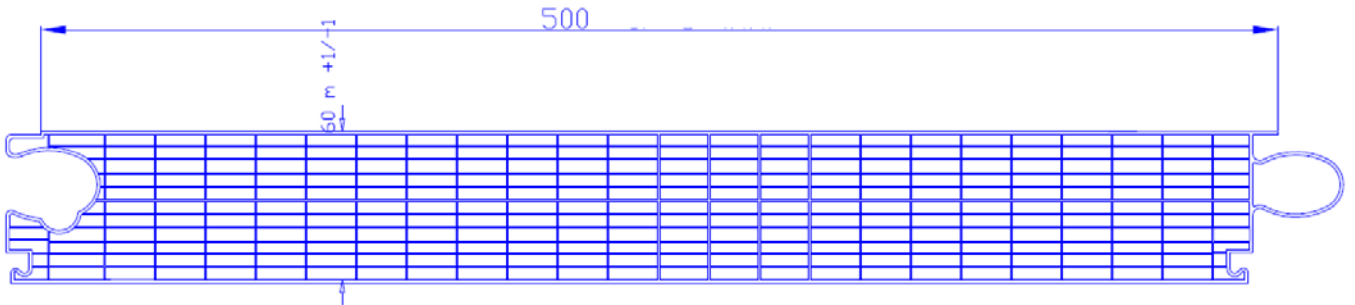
largeur panneau AKYVER Panel 60 (en mm)
